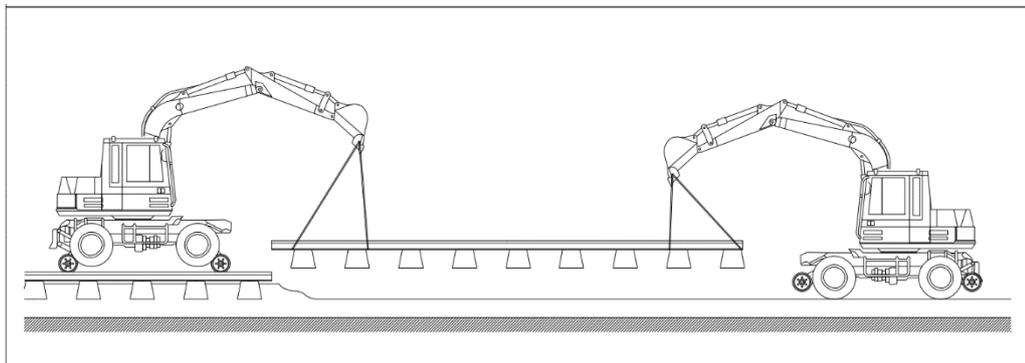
Colocación vía nueva por parejas [Fuente: elaboración propia]
